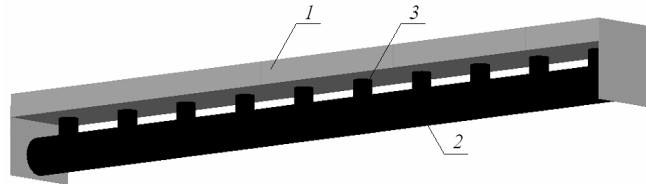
Сталезалізобетонна балка з армуванням трубами
